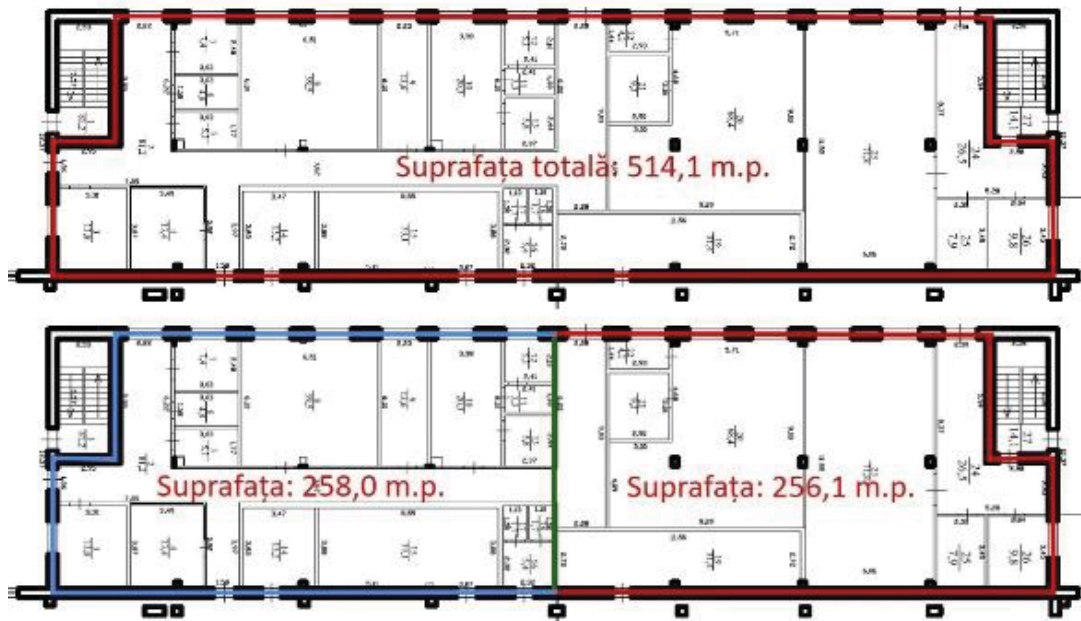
Planul construcției Partea 1, înainte de separare, după separare
